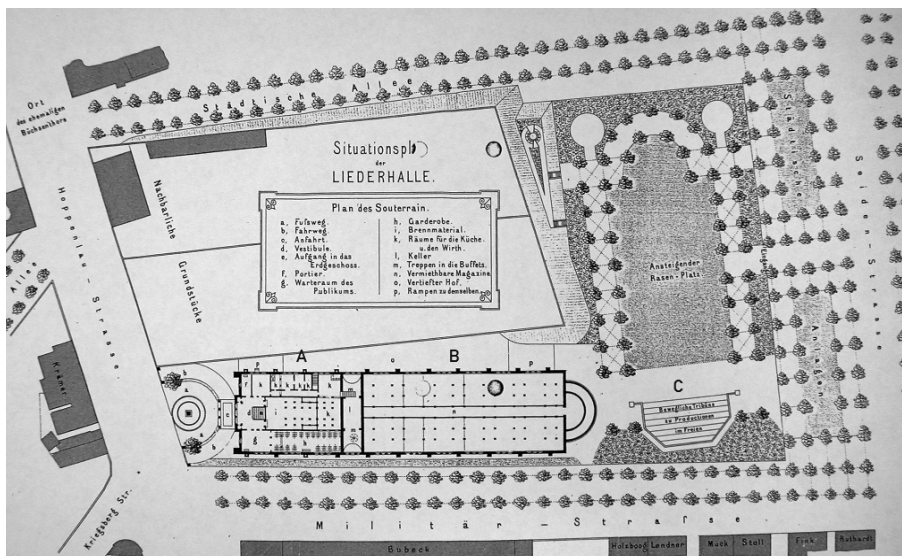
Lageplan »Alte Liederhalle«, 1885.
